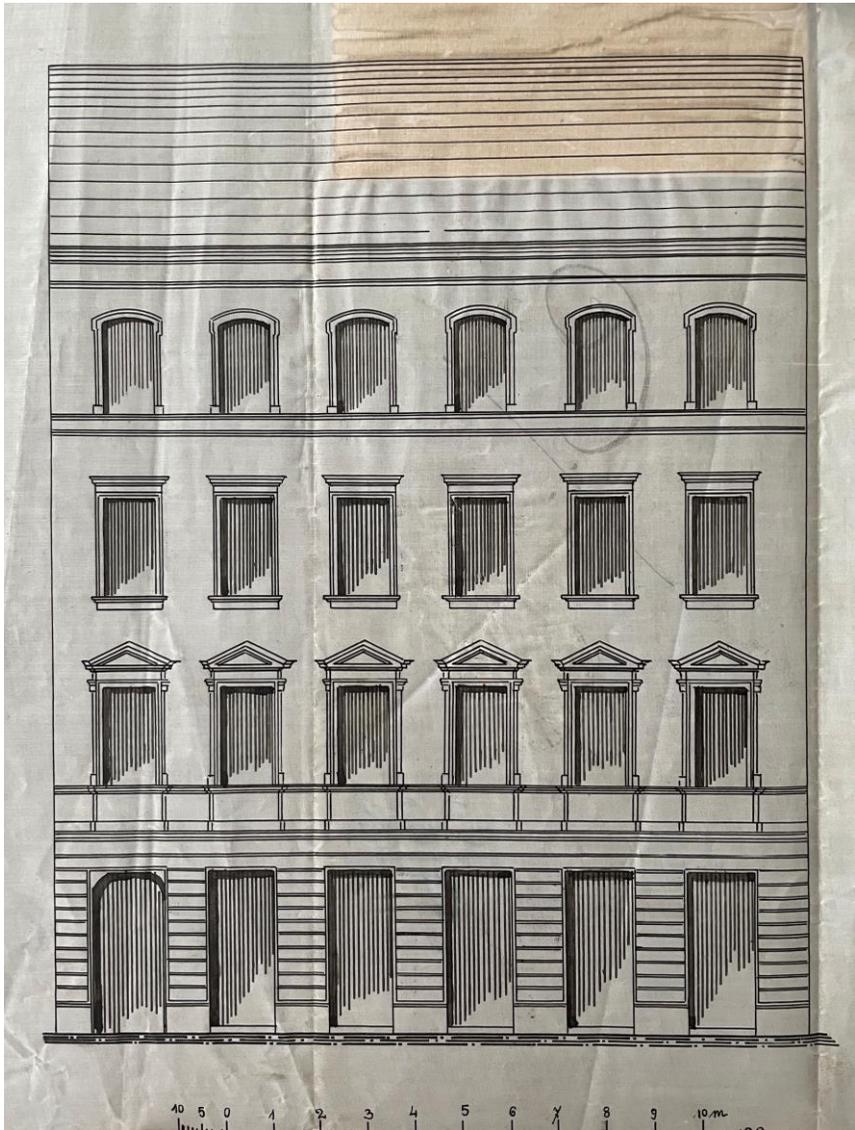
Fassade der Gumpendorfer Straße 88 laut Einreichplan.
